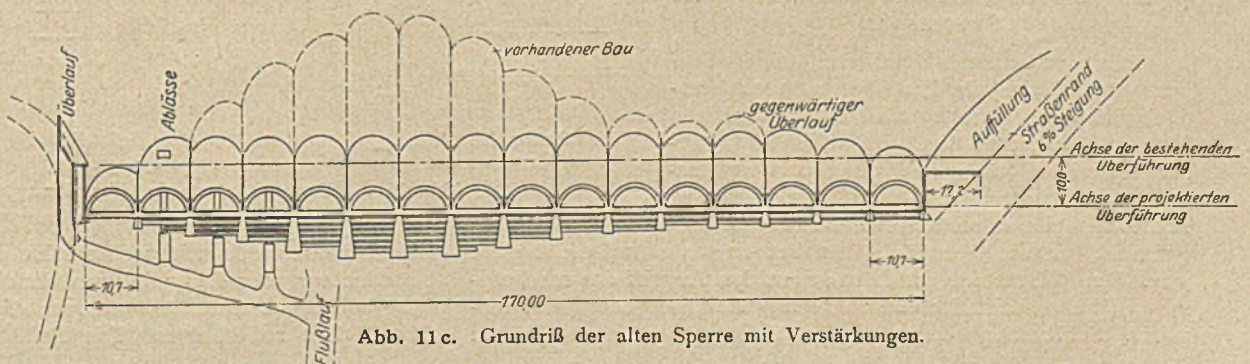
Grundriß der alten Sperre mit Verstärkungen.
